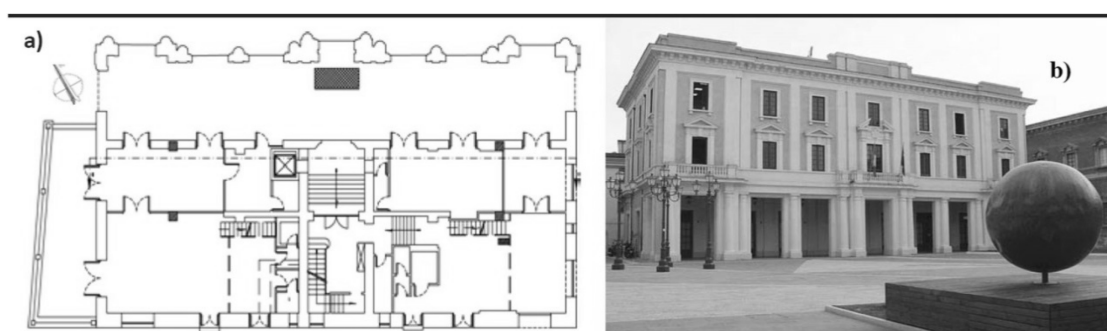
Architettura attuale: a) planimetria del piano terra; b) vista dell'edificio dal lato di piazza Roma.
